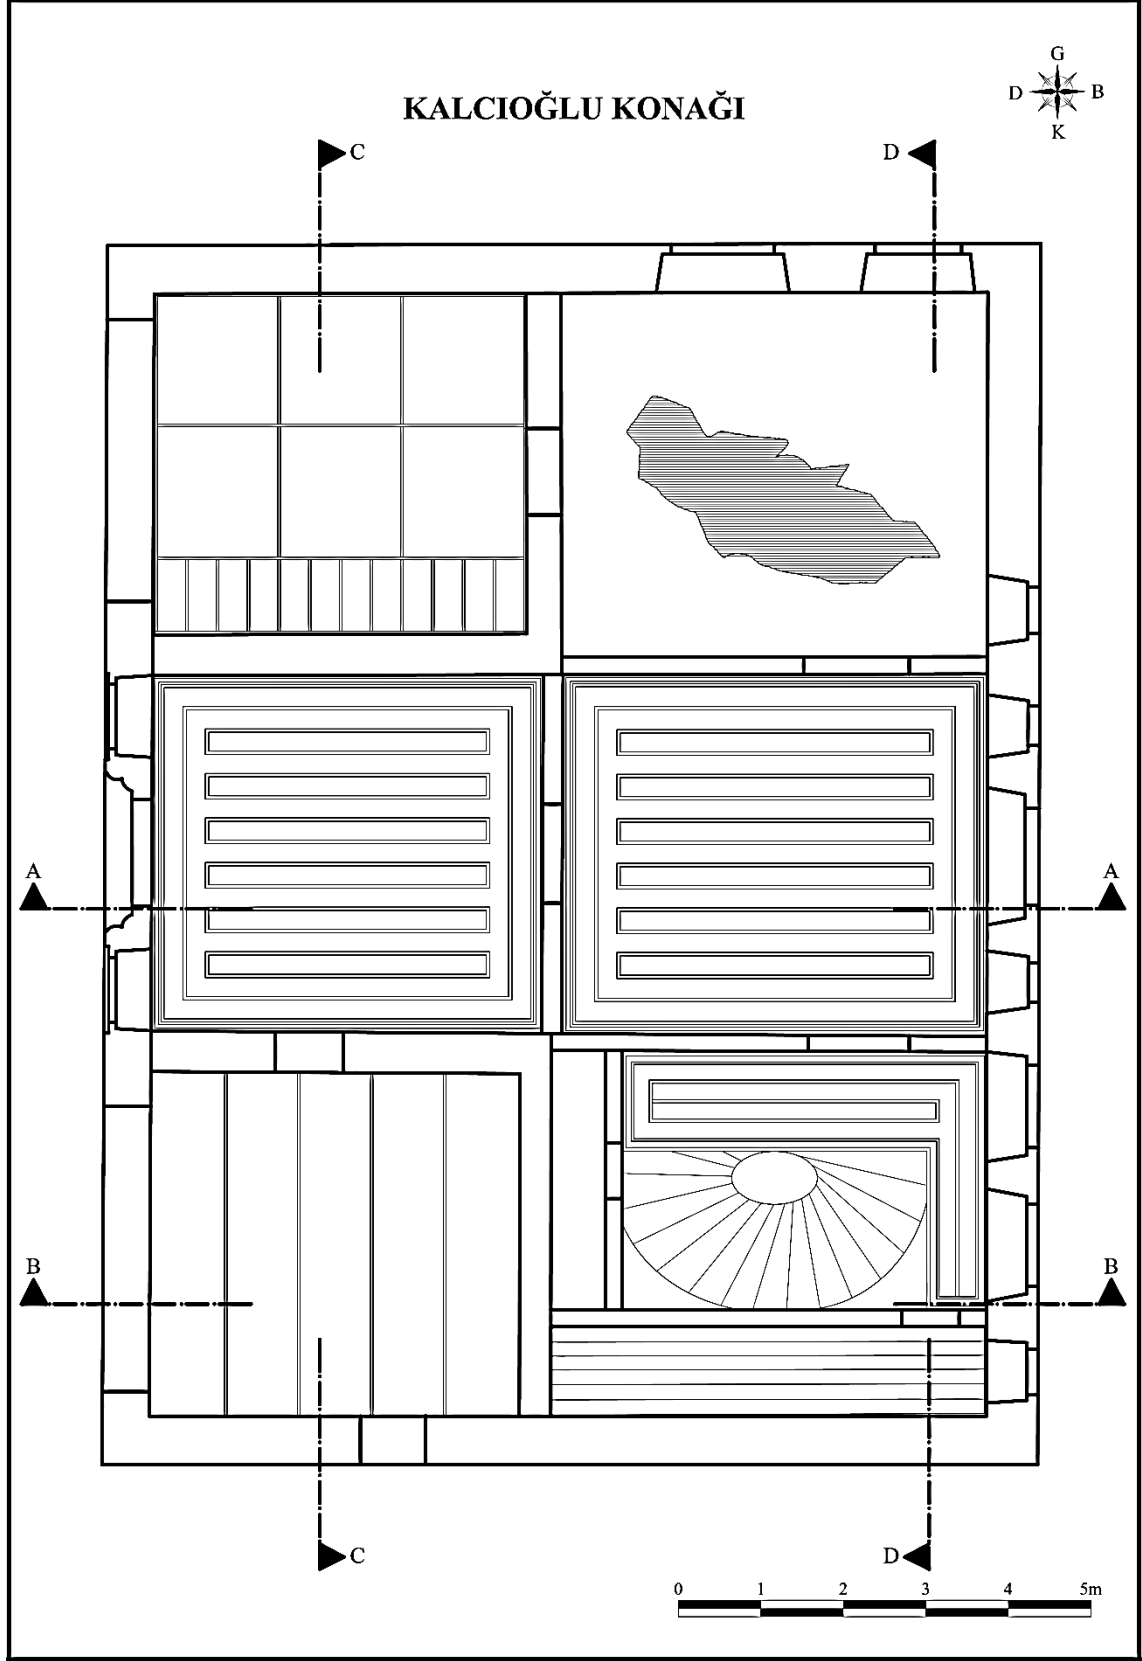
Rölöve- 2. Kat Planı (Turhan, 2013)
